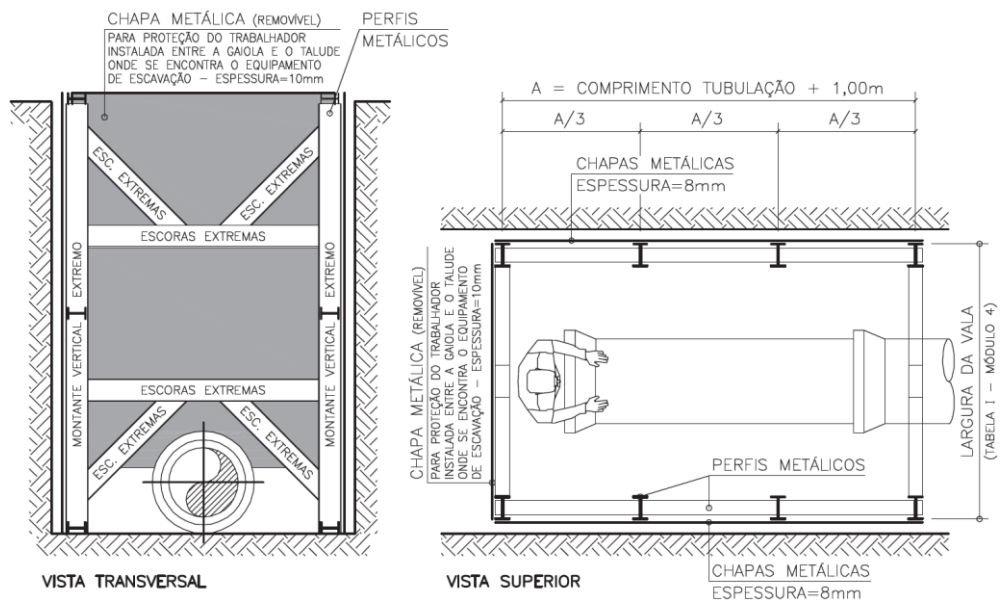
Detalhe em planta do escoramento metálico tipo blindagem (gaiola)
